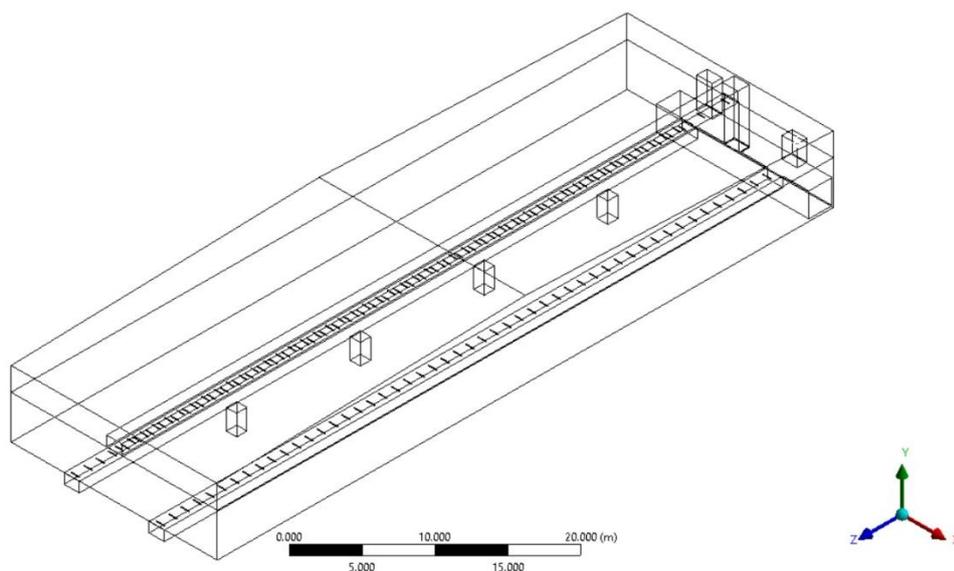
Módulo de climatización convencional de la planta de hilandería.
